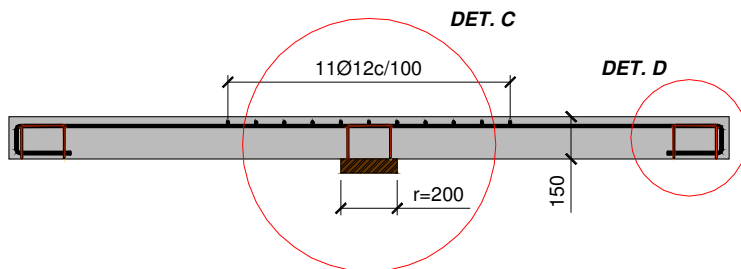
Detalhe das armaduras das lajes de CRFA (Continua)
